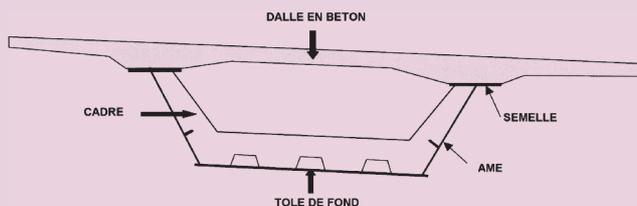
Caisson simple ouvert (cas d'une chaussée monodévers)
